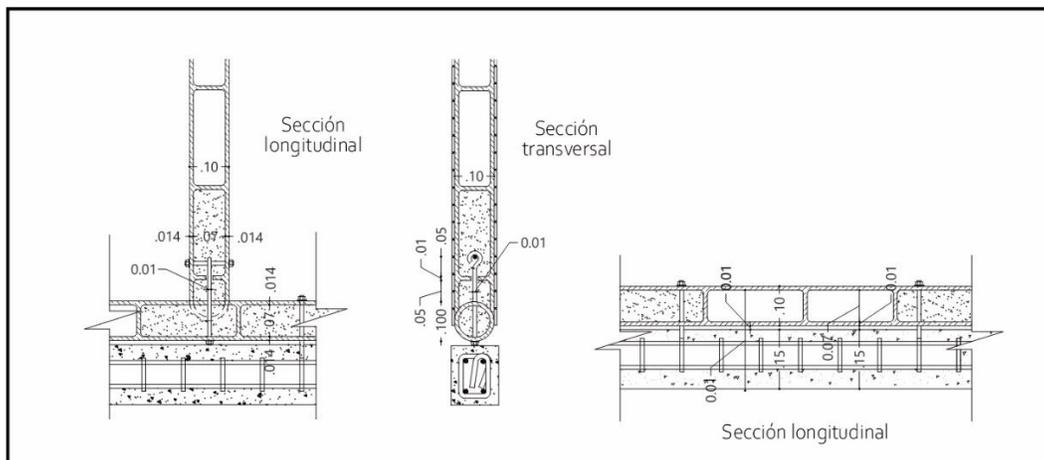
Unión inferior con pernotensor y sistema de anclaje entre viga de cimentación y la guadua
